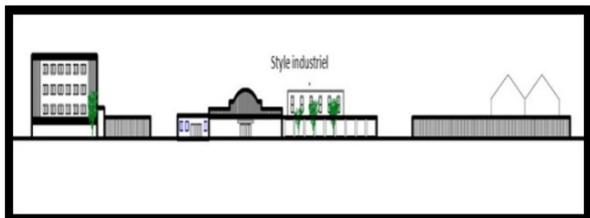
Façade sur boulevard Rouchai Boualem(sud)
